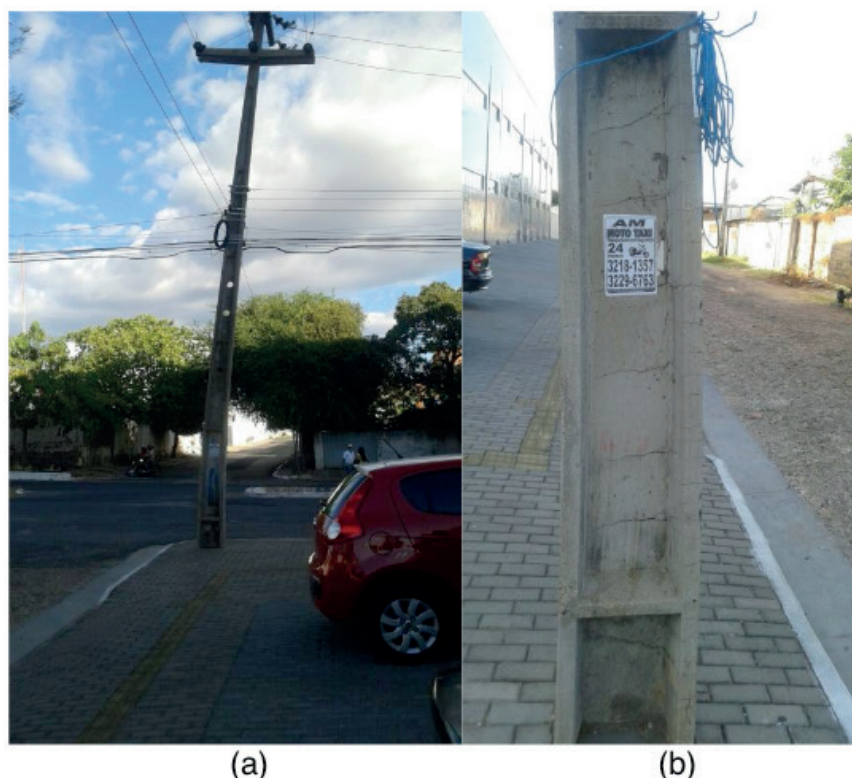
Poste deformado após carga excessiva (a) e poste apresentando fissuras (b)/
